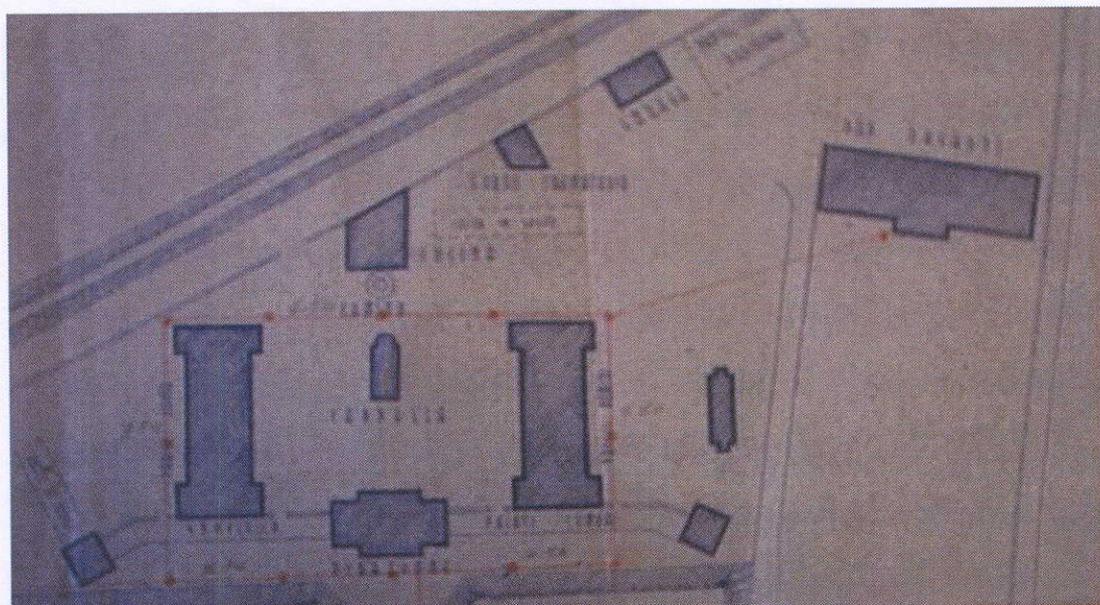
Particolare della planimetria di progetto per il nuovo impianto idrico (1948).
